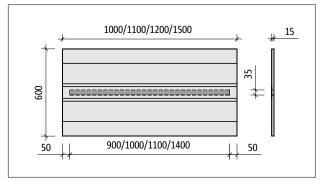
Schöck Tronsole® tipo B-V2-L...-B600, pianta del prodotto
